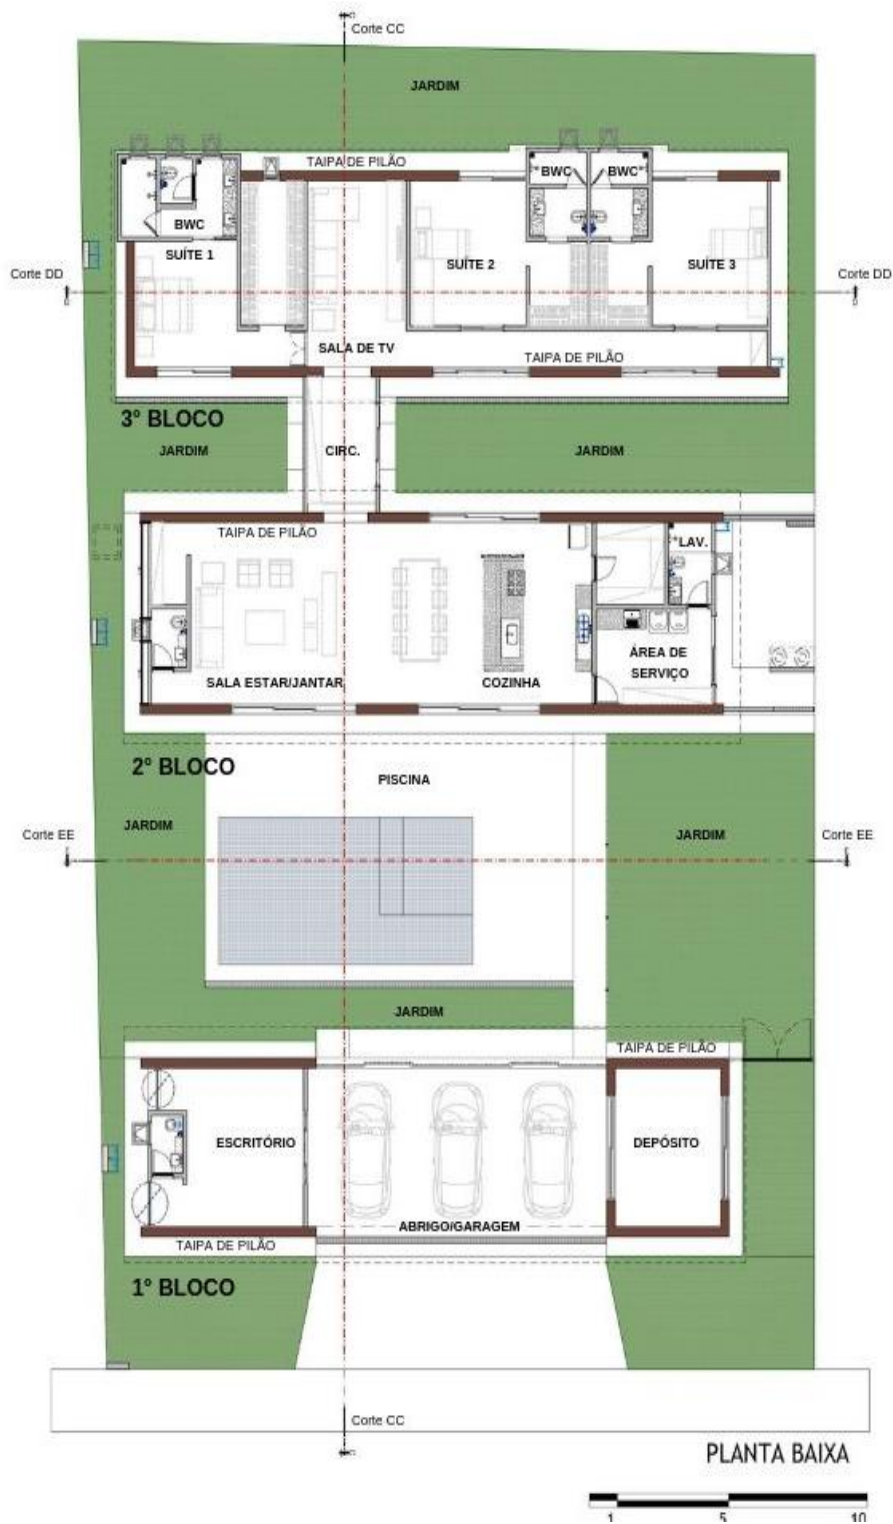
Planta Baixa Casa Colinas / FATO Arquitetura.
